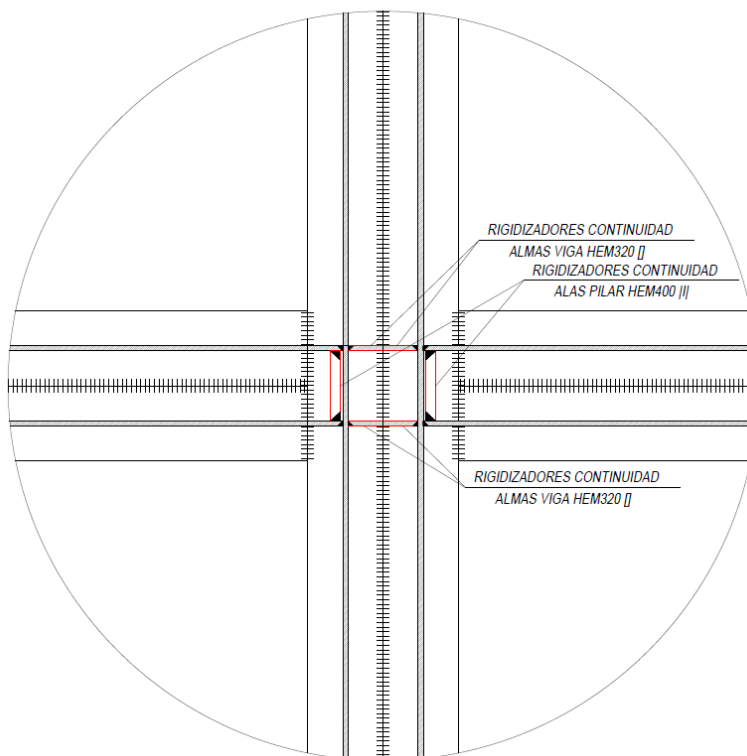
Rigidizadores de alas de pilar y almas de viga.
